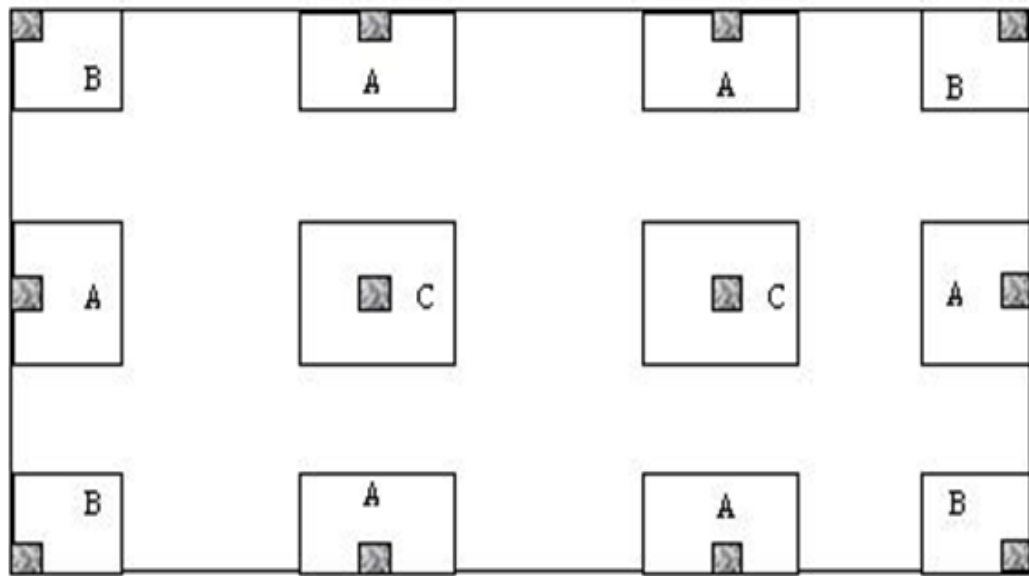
Zapatas aisladas, medianera (A), Esquina (B) e Interior (C). (Fuente: Martínez, 2003.)
